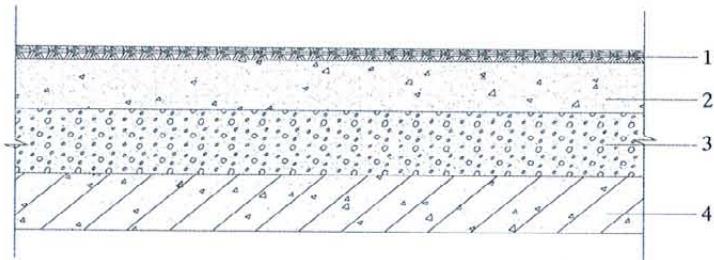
现浇轻质泡沫混凝土车库垫层构造示意
